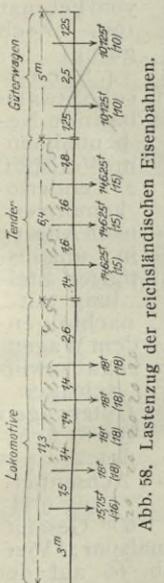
Lastenzug der reichsländischen Eisenbahnen.
